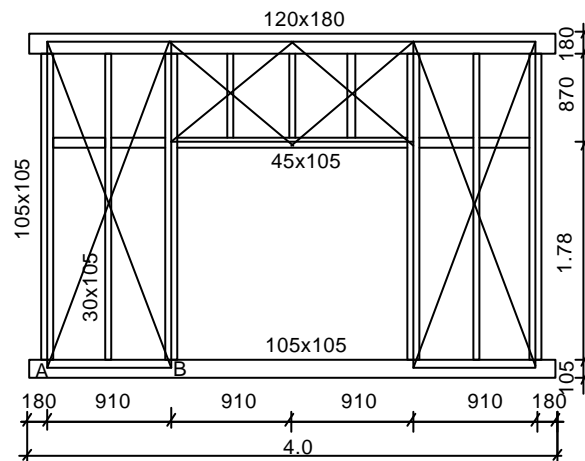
Mur de contreventement P2 (porte).* Shear wall P2 (door)
